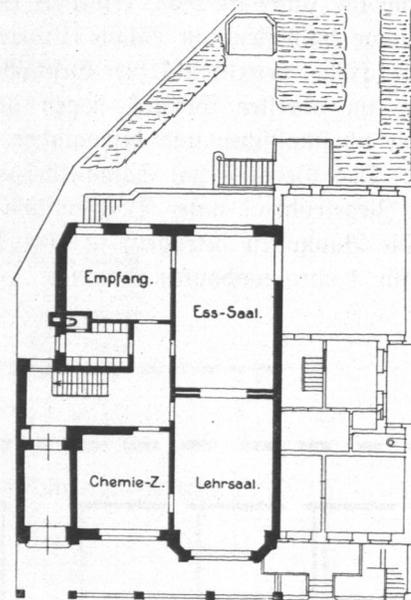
Haushaltungsschule Wallstraße, Erdgeschoss.
